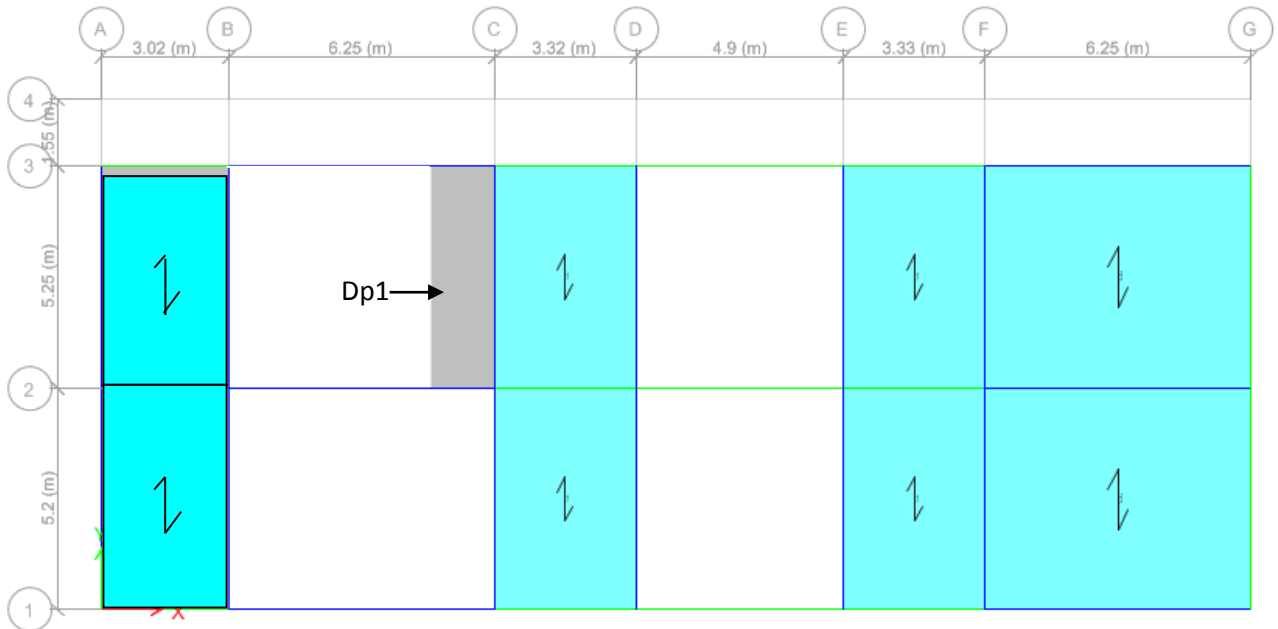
Plans Disposition des poutrelles étage (RDC)
